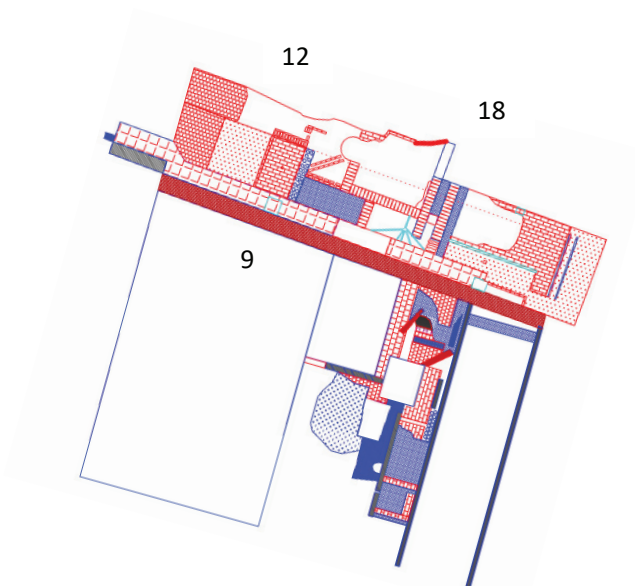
Planta de las estructuras relevadas en los lotes 9, 12 y 18. En rojo oscuro muro medianero entre los tres lotes.
